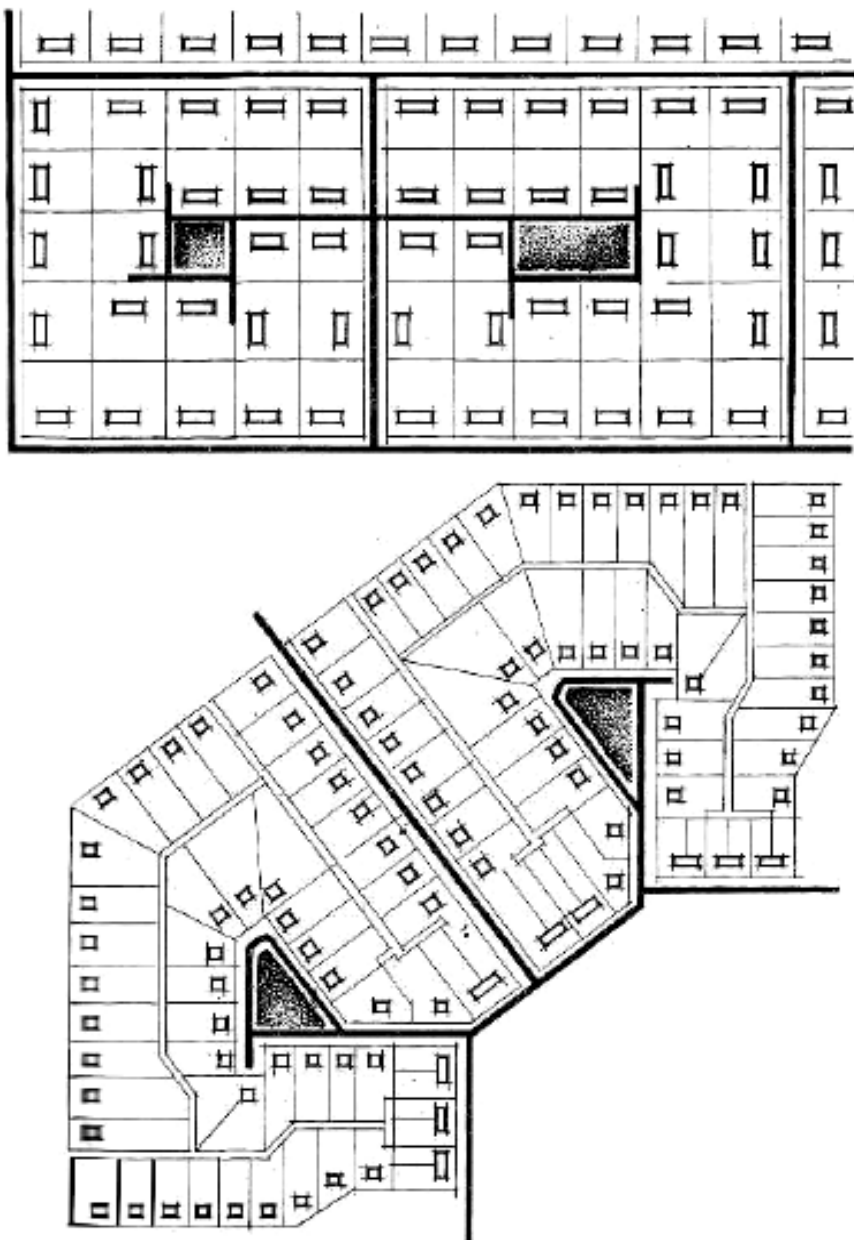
Варіанти планування збільшених кварталів садибної забудови.
